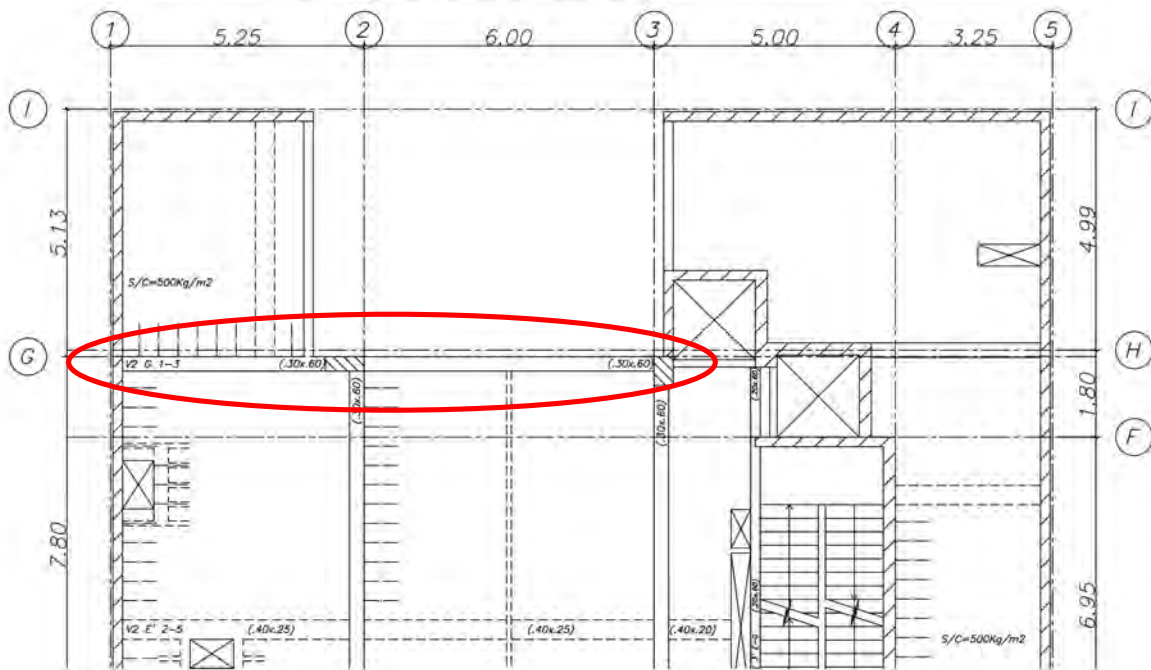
Ubicación de la Viga “V2 G 1-3”
